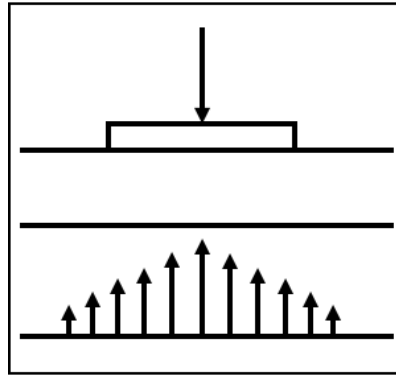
Distribución De Esfuerzos De Un Pavimento Flexible.
